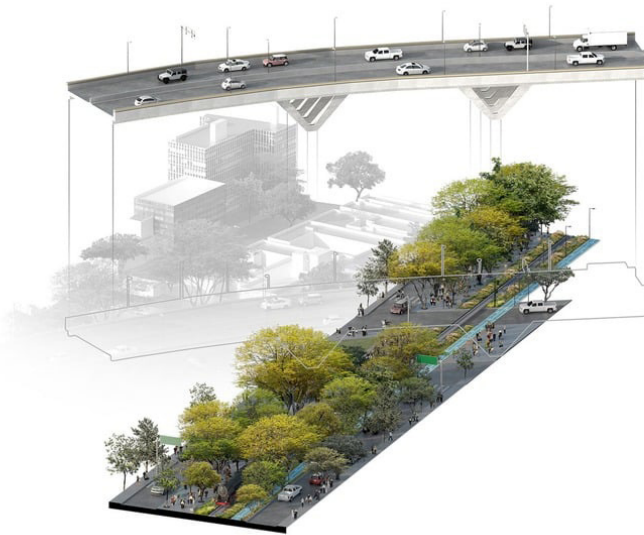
Sección transversal del proyecto. Imagen recuperada de <https://www.archdaily.mx/886566/parque-lineal-ferrocarril-de-cuernavaca-gaeta-springall-arquitectos>
